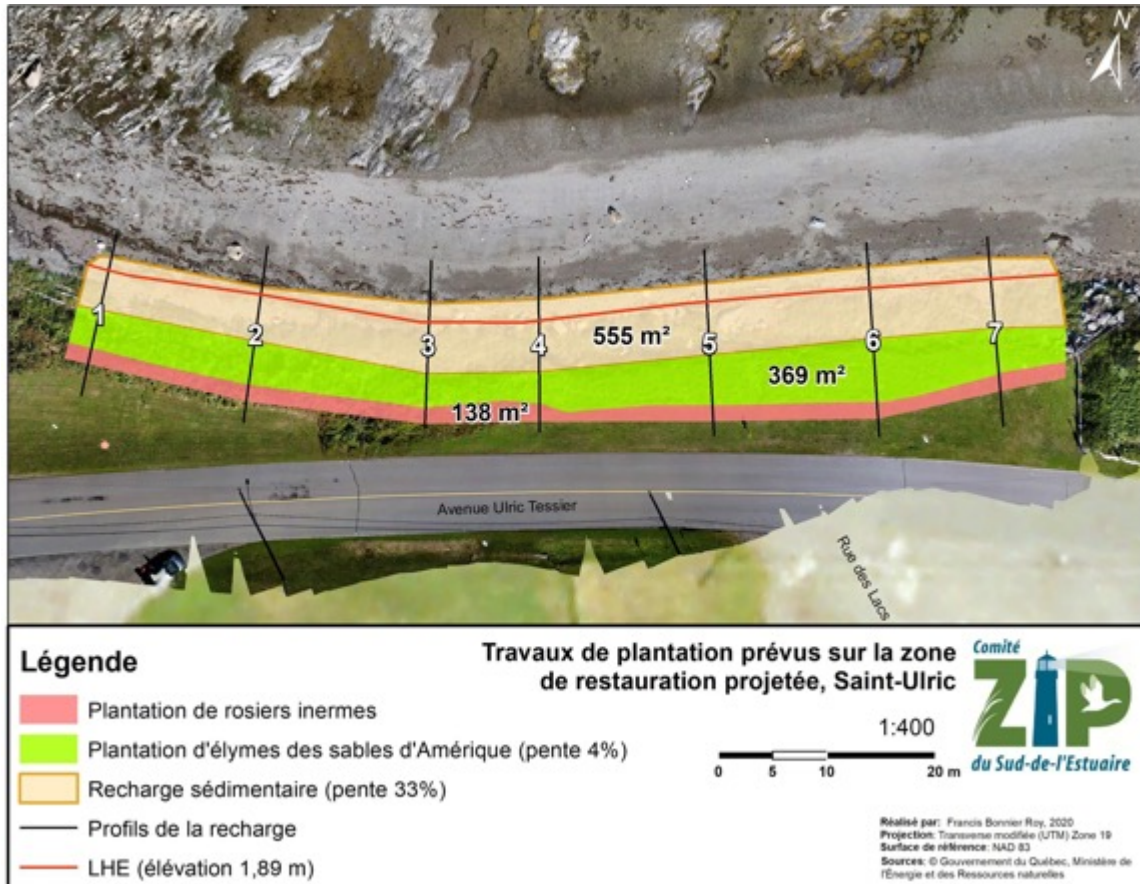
Travaux de plantation prévus dans la zone de restauration projetée, Saint-Ulric.
